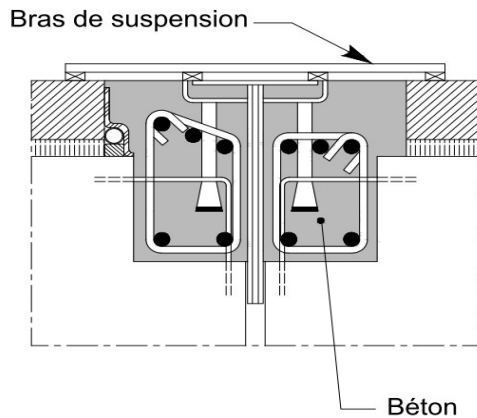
Calage des ancrages, réglage du joint par rapport au revêtement adjacent et bétonnage
